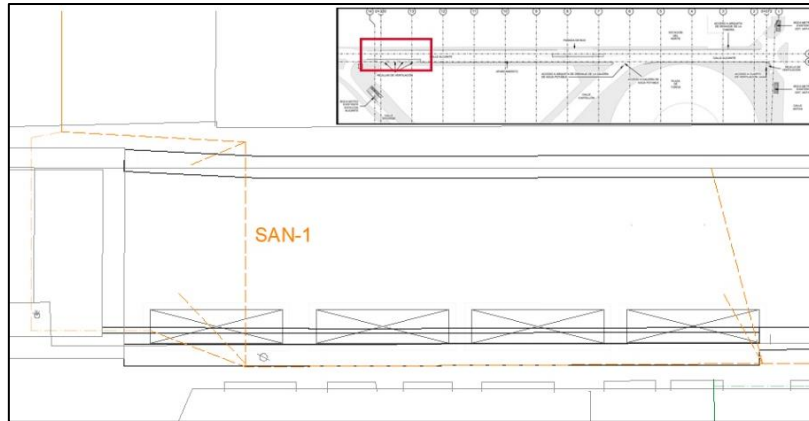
Plano de reposición SAN-SAN1-SR-CX-F9
